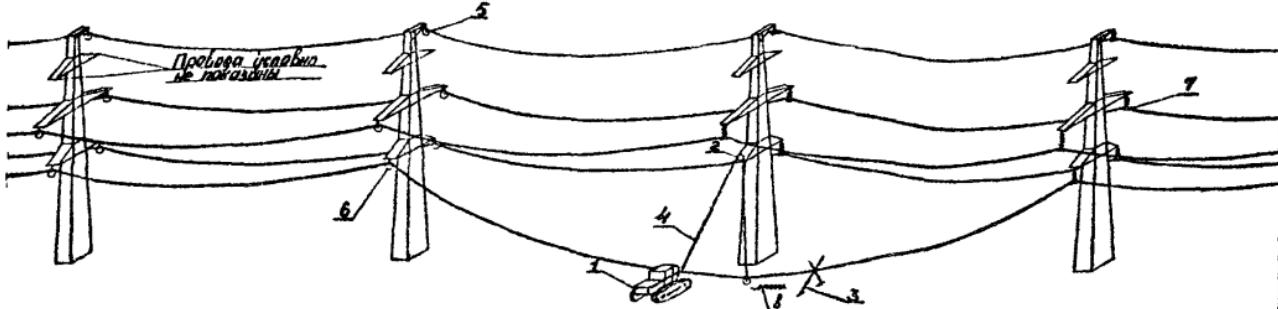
Узел Я. Перекладка провода верхней траперсы с опусканием
